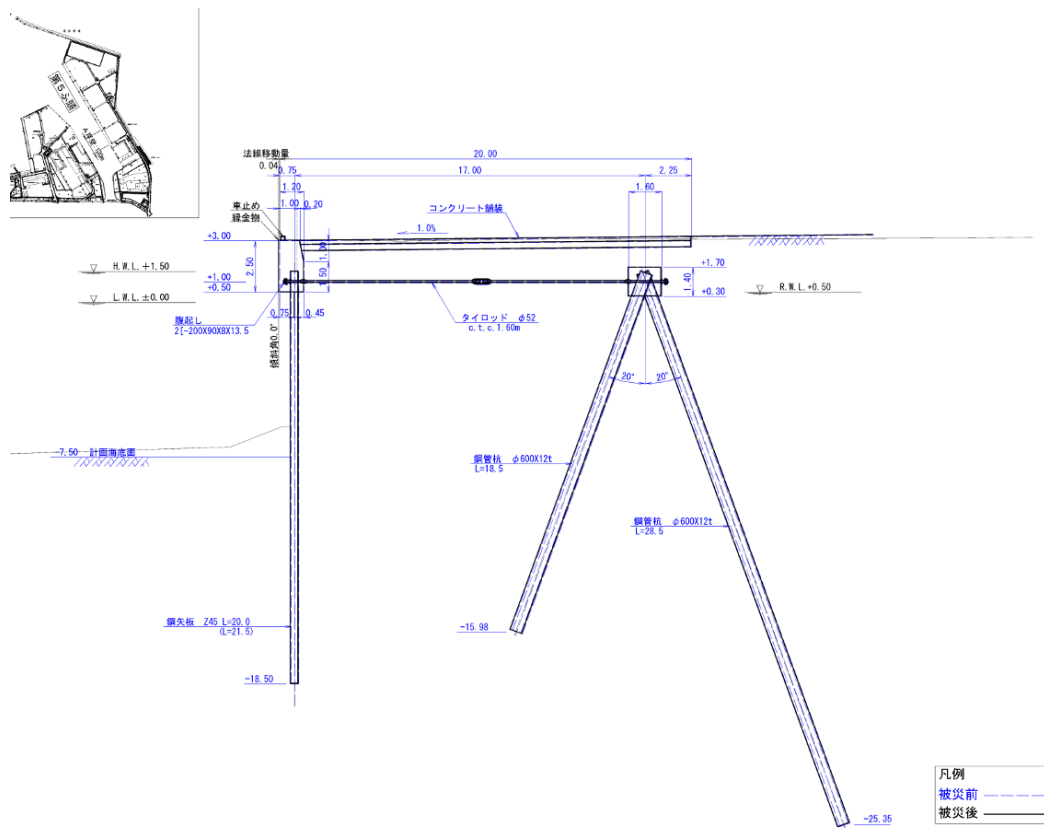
No.13 日立港区\_第5ふ頭地区 5-A 岸壁 (-7.5m) の断面図 (被災前・後)
